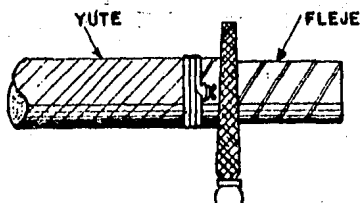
CORTE DE LA ARMADURA DE UN CABLE SUBTERRANEO PARA SU POSTERIOR TAPONADO
